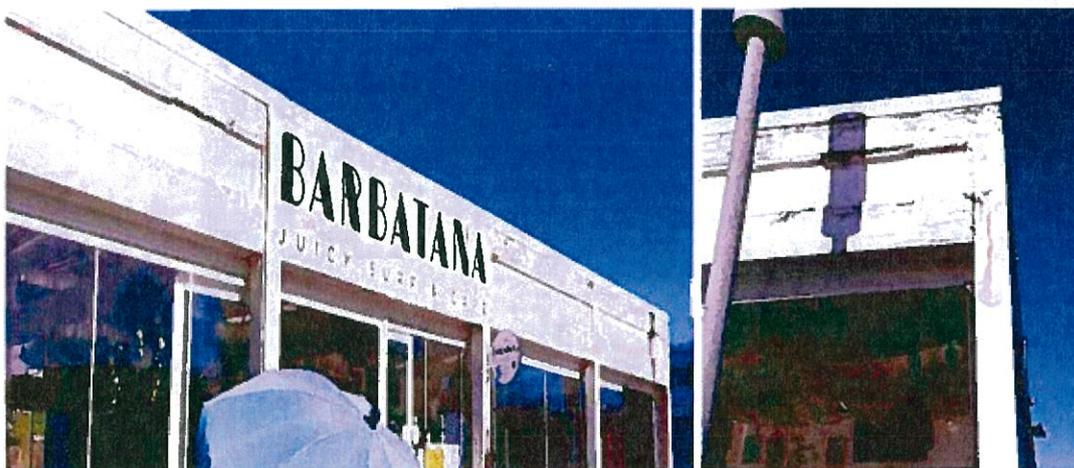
/ 1.2 - Fachada principal: deterioração da pintura e sinais de infiltração
